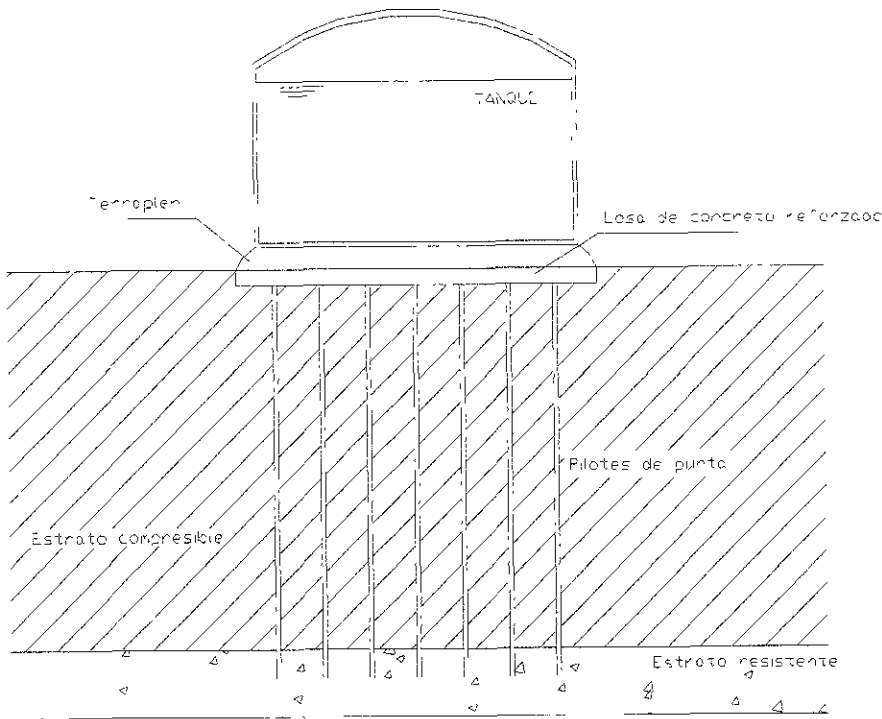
a Cimentación rígida sobre pilotes de punta
